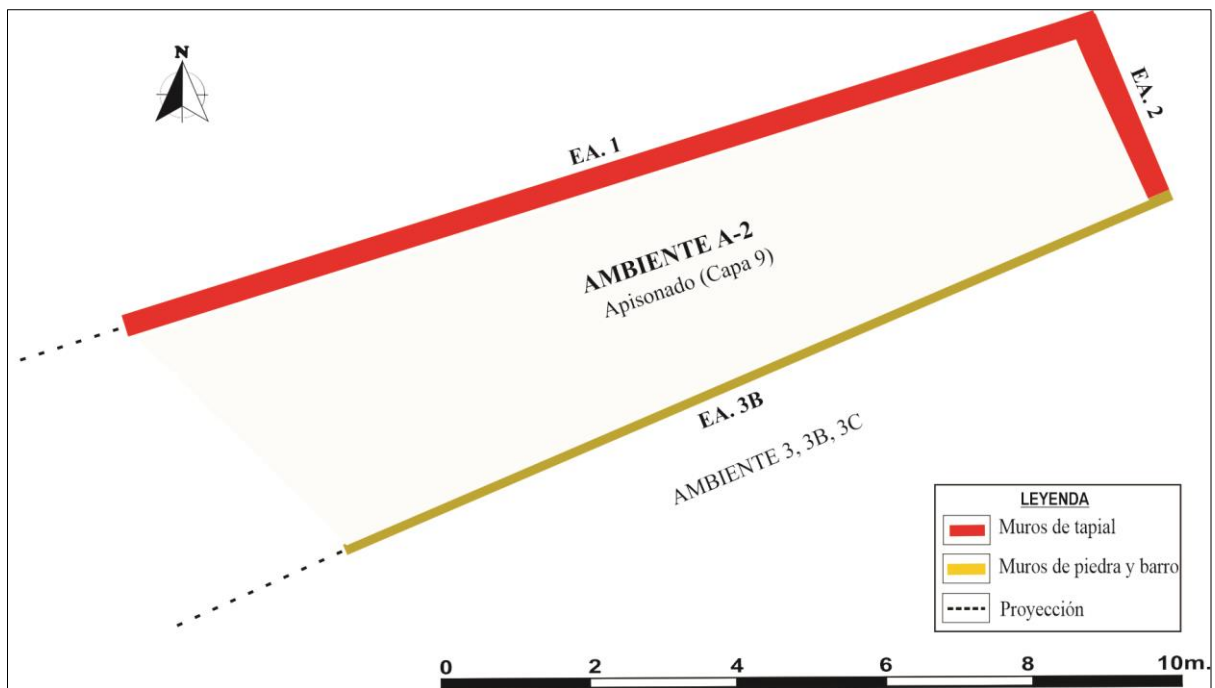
Planta arquitectónica del Ambiente 2 (A-2). Primer Momento Constructivo (I).
